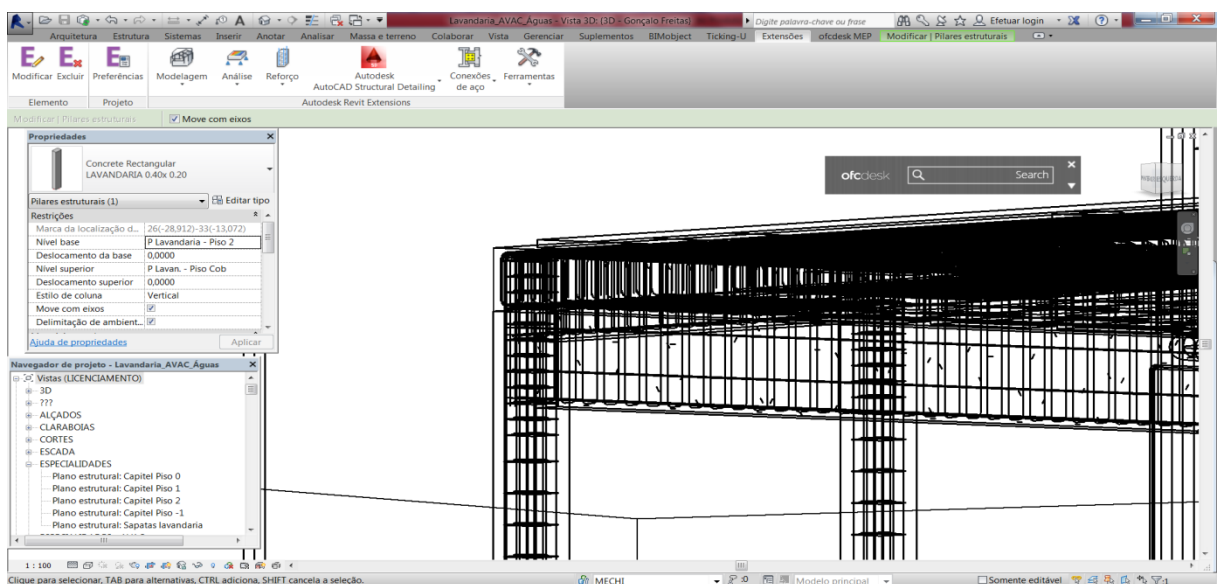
Visualização tridimensional da armadura na interseção de duas vigas com um pilar.
